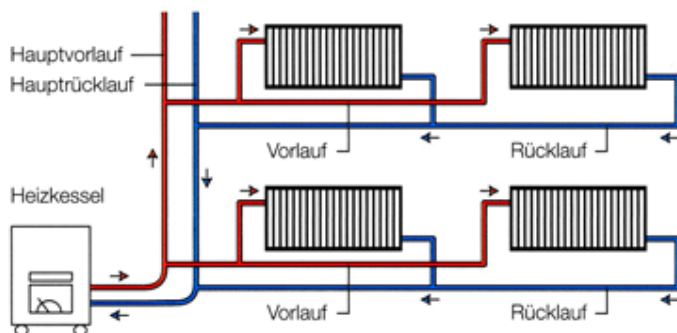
Heizungsschema eines Zweirohrsystems<sup>98</sup>
